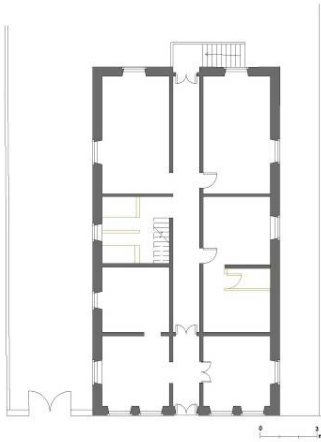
Planta Casa Av. Borges de Medeiros, 766
